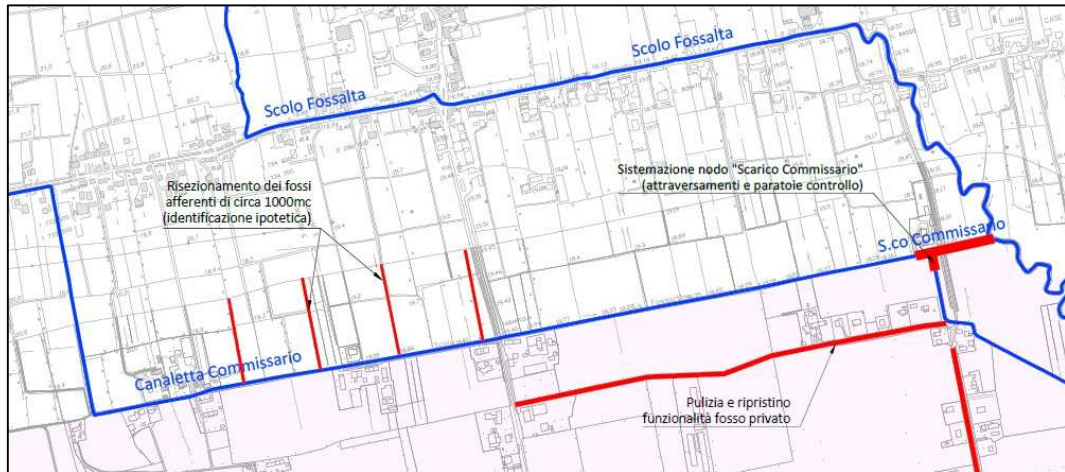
Estratto tavola interventi 03.04.01 del Piano delle Acque di Borgoricco, Massanzago e Villanova di Camposampiero
